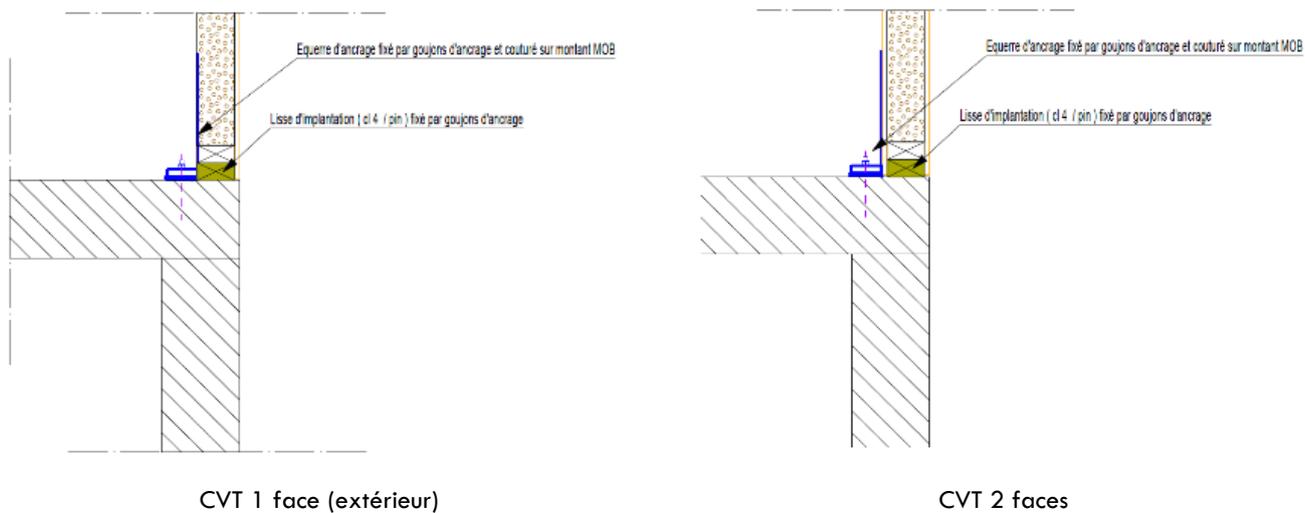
Coupe de principe d'ancrage (traction) des éléments préfabriqués à la dalle
